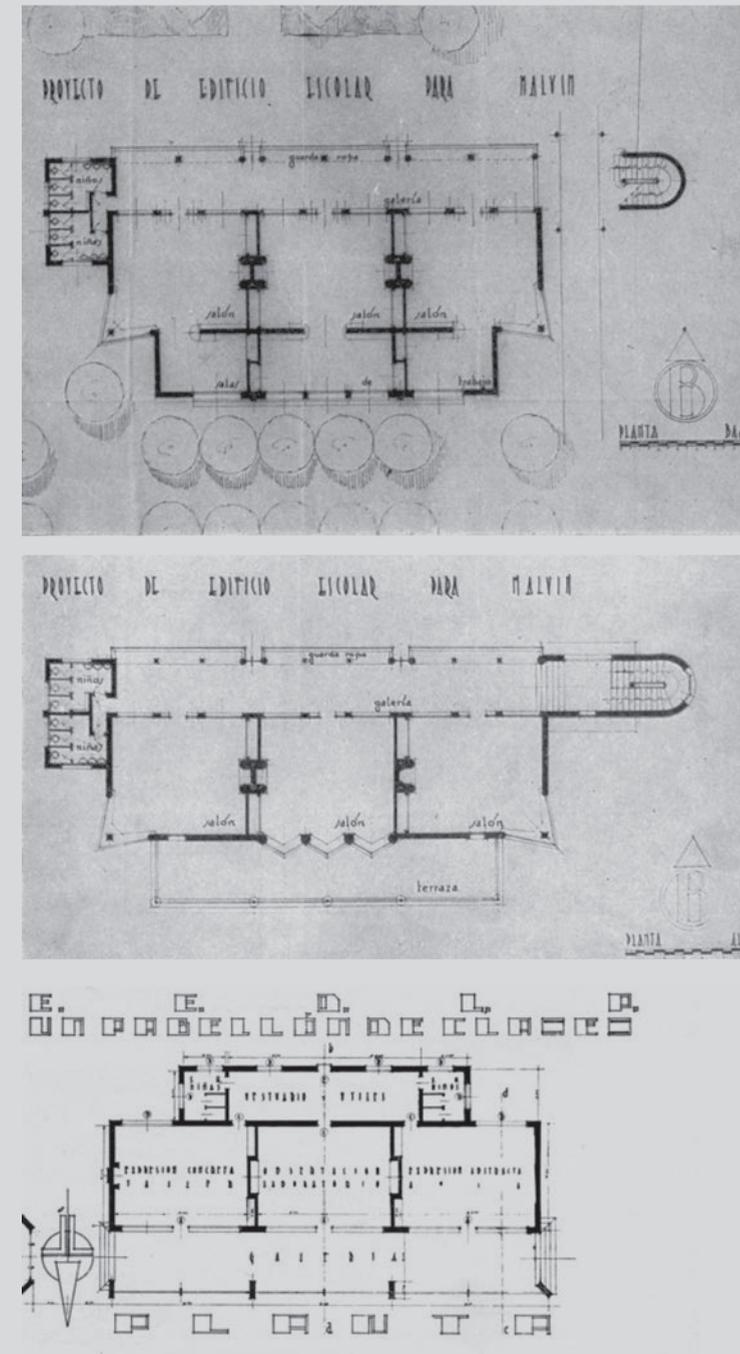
PLANTAS DEL PABELLÓN DE AULAS DE LAS DOS ESCUELAS EXPERIMENTALES A LA MISMA ESCALA (ARRIBA, LA DE MALVÍN, EN DOS NIVELES; ABAJO, LA DE LAS PIEDRAS, EN UN NIVEL). EL NORTE ESTÁ HACIA ABAJO EN LA PLANTA DE LAS PIEDRAS.
